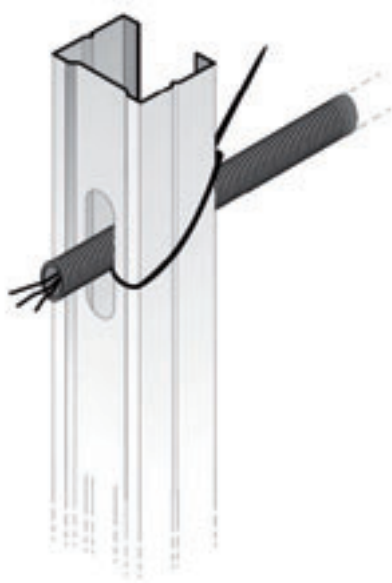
Detalle instalación eléctrica entubada y caja de conexiones.
